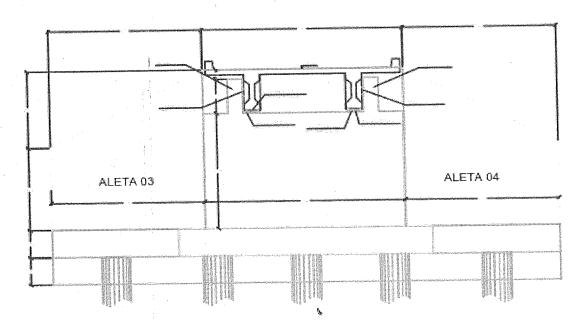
Viga cabezal 02 (Vista Frontal) – Cimentacion de los estribos y/o aletas. Fuente: DISEÑO ESTRUCTURAL<sup>23</sup>.
